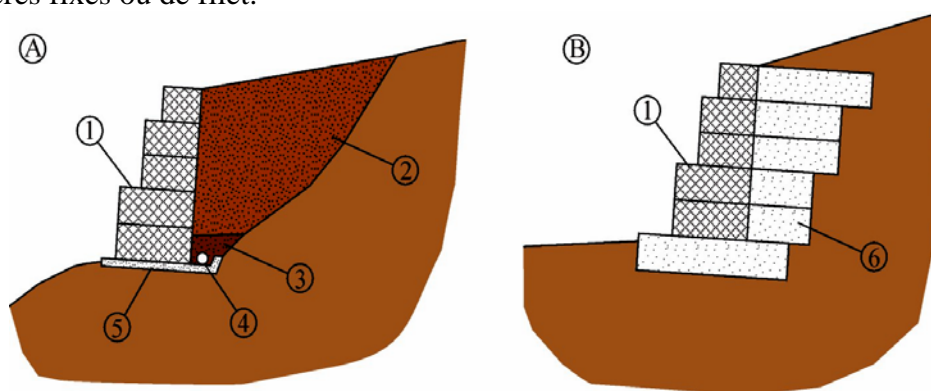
2 : Schéma de principe de gabions (modifié d'après APAT, 2001). 1) Ecran de gabions; 2) Matériel de remplissage; 3) Matériel drainant; 4) Tuyau drainant; 5) Semelle de fondation; 6) Eperon drainant. Les gabions sont des structures perméables qui permettent un bon drainage du terrain. Dans les interventions d'aménagement et de stabilisation des pentes en mouvement (A), une couche de matériel drainant et une semelle en béton sont positionnées à la base du mur pour collecter et évacuer les eaux de la nappe à l'aide de tuyaux drainants. Les gabions peuvent être utilisés comme éperons drainants (B) associés à des structures de soutènement réalisées elles-mêmes en gabions.
